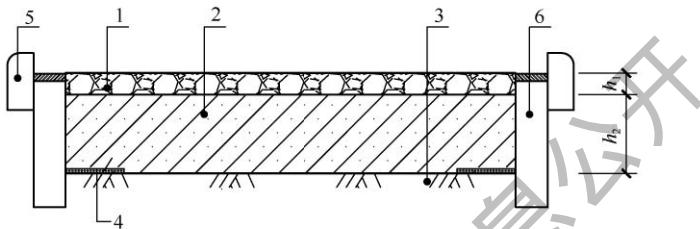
透水水泥混凝土路面排水形式（横断面）
